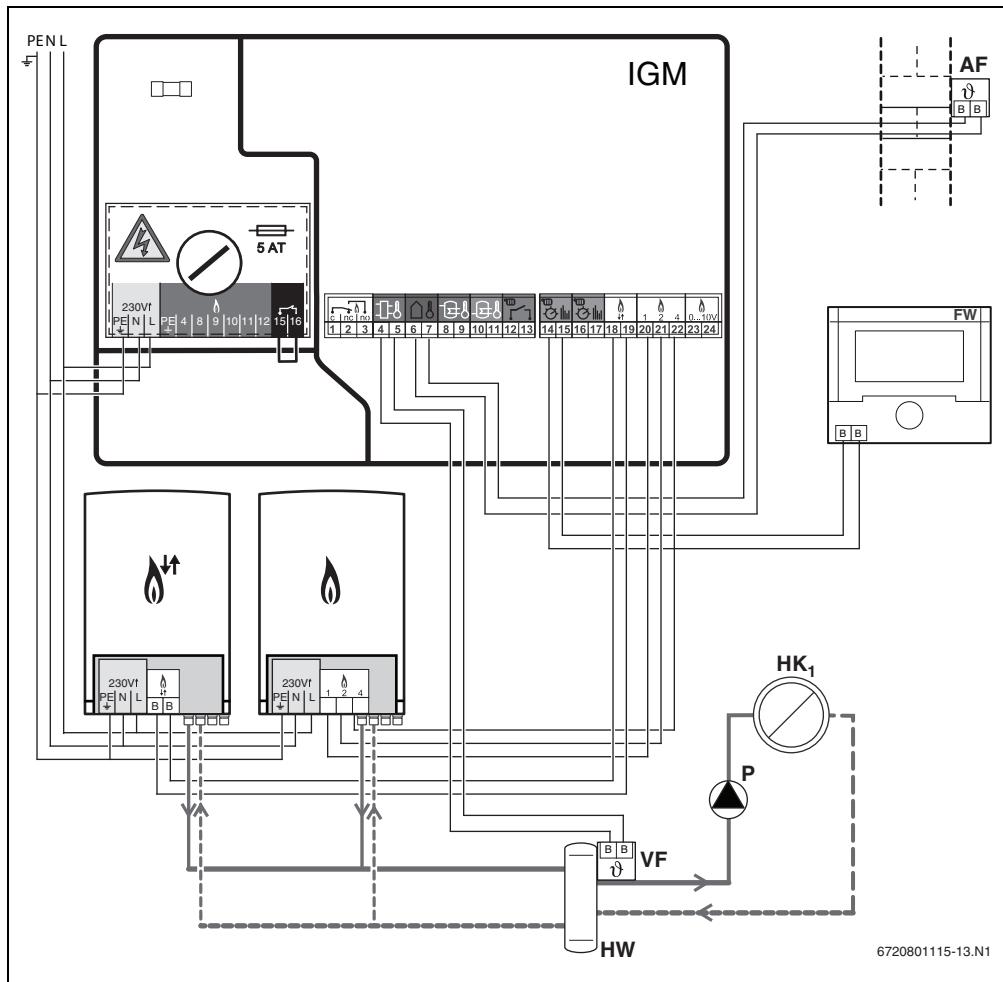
Schema elettrico di collegamento con compensatore idraulico
